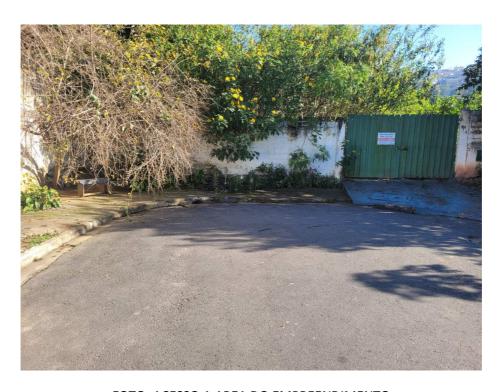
FOTO: ACESSO A AREA DO EMPREENDIMENTO
